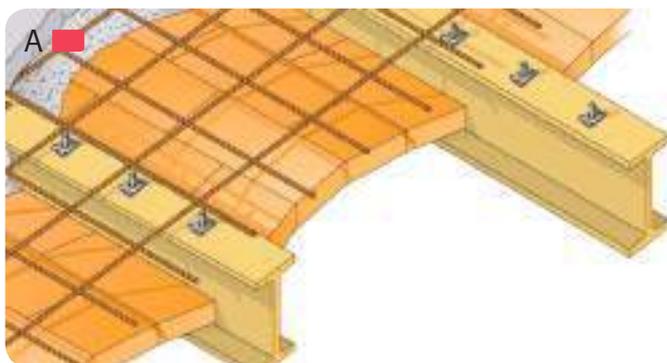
Усиление сталекирпичных перекрытий путем обеспечения совместной работы с монолитной плитой с постановкой анкерных упоров по верхним поясам балок
